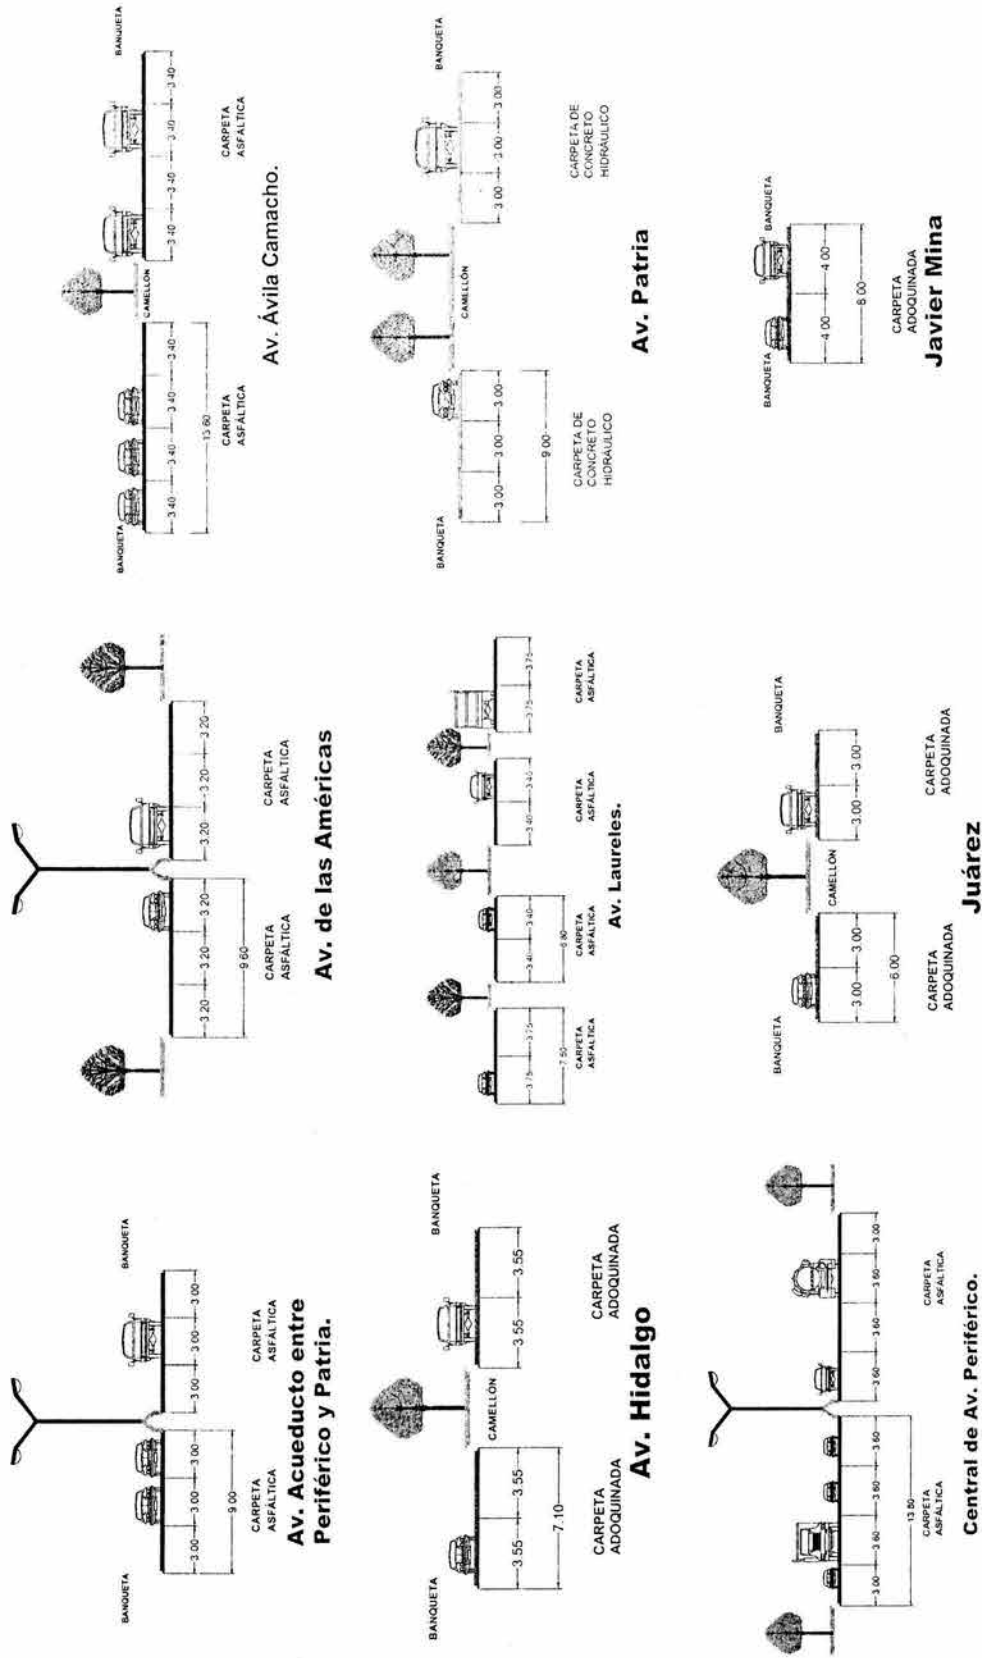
Secciones transversales de algunas avenidas y calles de la zona del centro de Zapopan.
